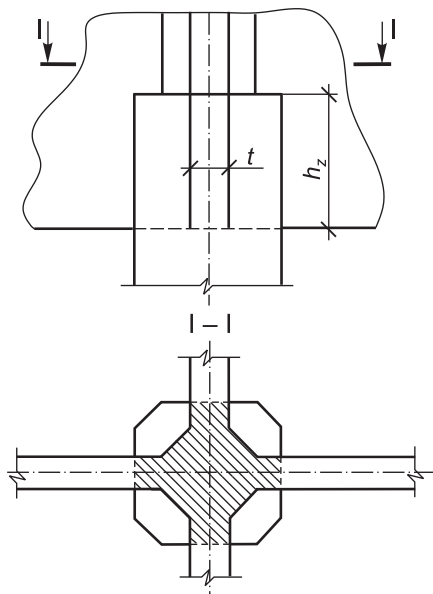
Заделка колонны подсилосного этажа, бетонируемой в скользящей опалубке, в стены силосов
